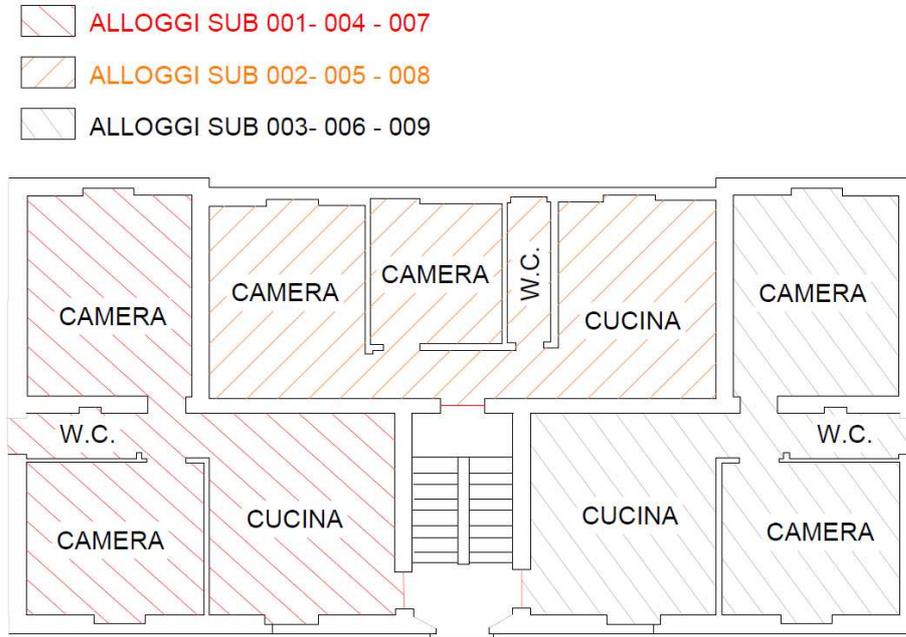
Suddivisione piani fuori terra destinati ad alloggi.
